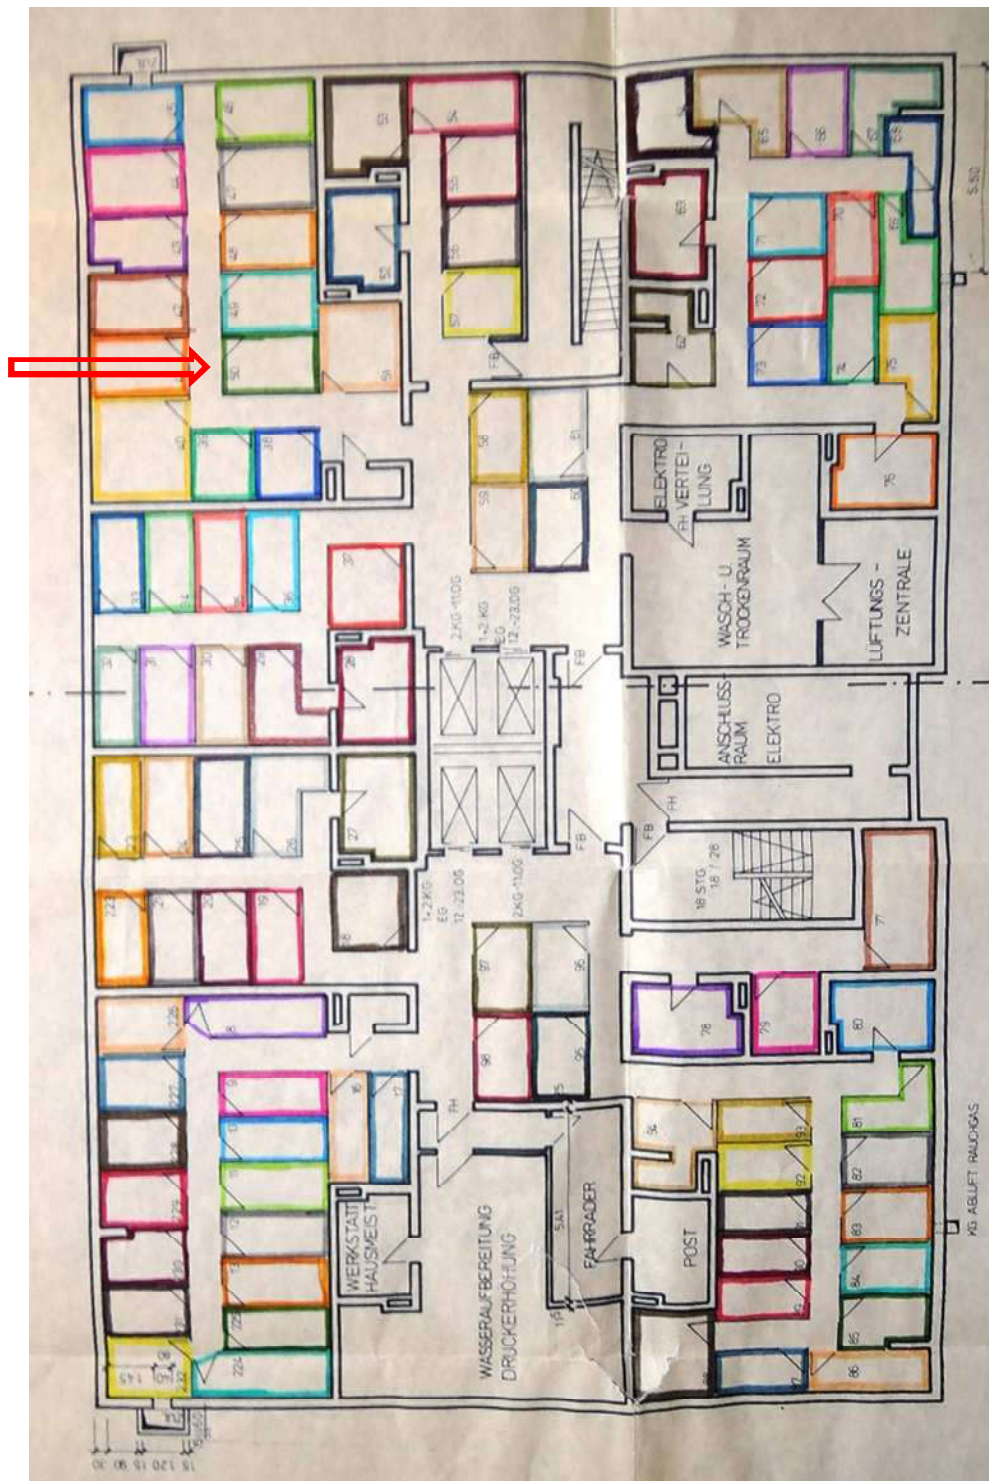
Grundrissplan 1. KG (aus Aufteilungsplan der Teilungserklärung)
